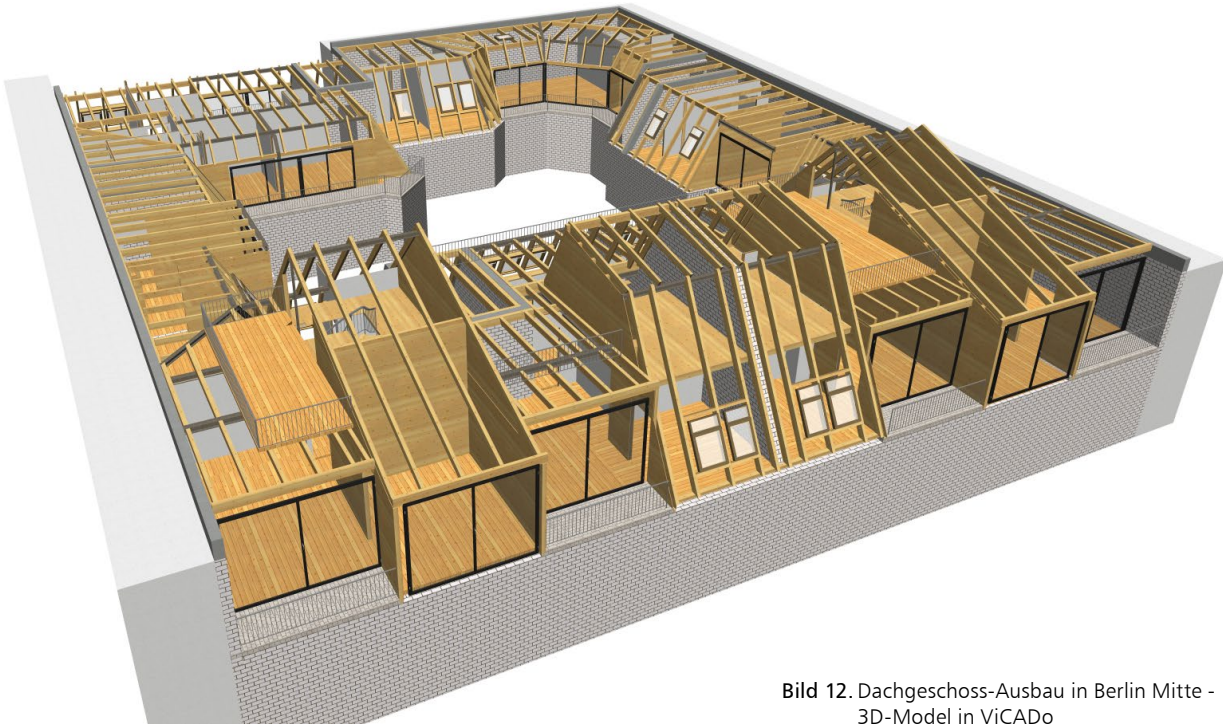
Dachgeschoss-Ausbau in Berlin Mitte - 3D-Modell in ViCADo
